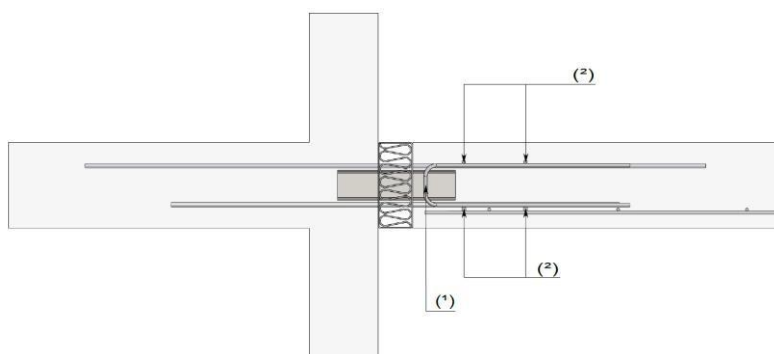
Disposition de ferrillage en rive de plancher - liaison dalle-balcon
